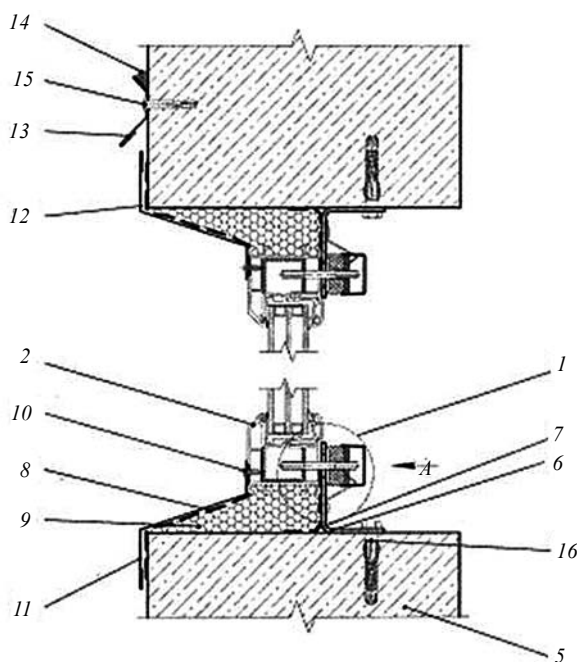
, а. Модель ЛСК⁹. Изображение схемы общего вида легкобрасываемой конструкции на базе блока оконного из поливинилхлорида: 1 — разрушаемый узел крепления рамы; 2 — легкобрасываемая конструкция; 5 — стеновой проем; 6 — базовый элемент (основание); 7 — лента; 8 — паропроницаемая и гидроизолирующая лента; 9 — утеплитель (минеральная вата); 10 — саморез с пресс-шайбой; 11 — нижний отлив; 12 — вентиляция для минеральной ваты утеплителя; 13 — желобчатая часть верхнего отлива; 14 — атмосферостойкий герметик; 15 — крепежные элементы; 16 — крепежные элементы (шпилек-саморезов)
